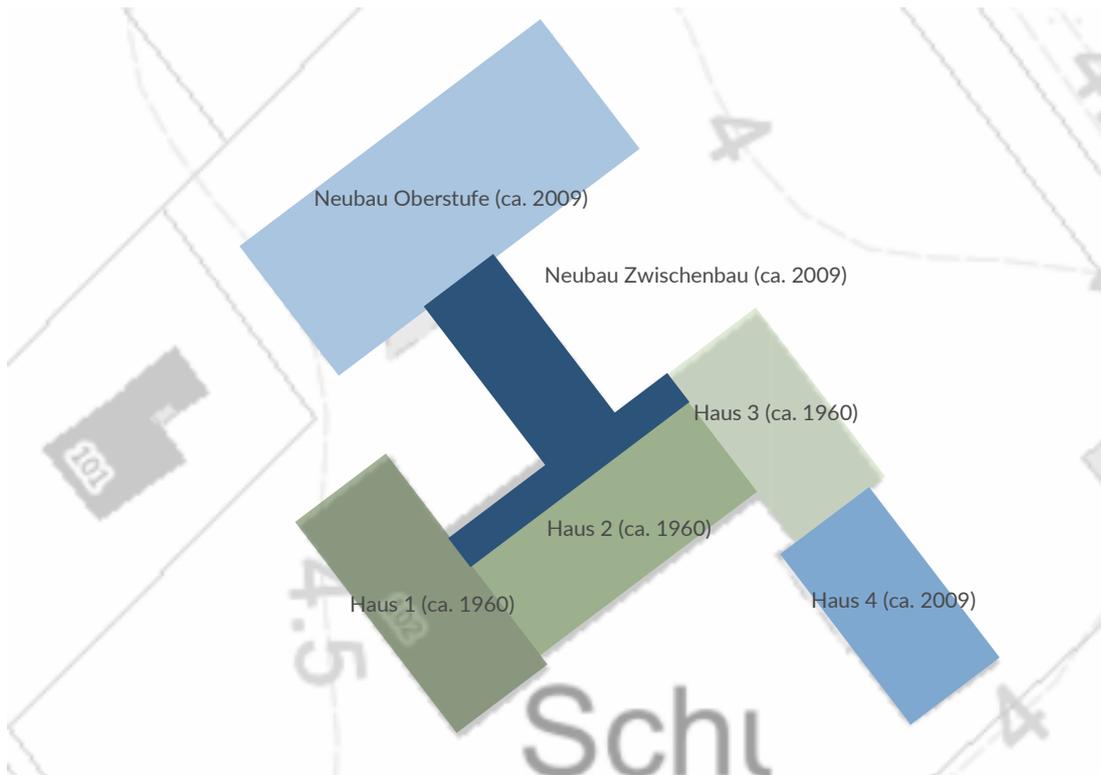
Lageplan, Aufteilung der Liegenschaft nach Baujahren
